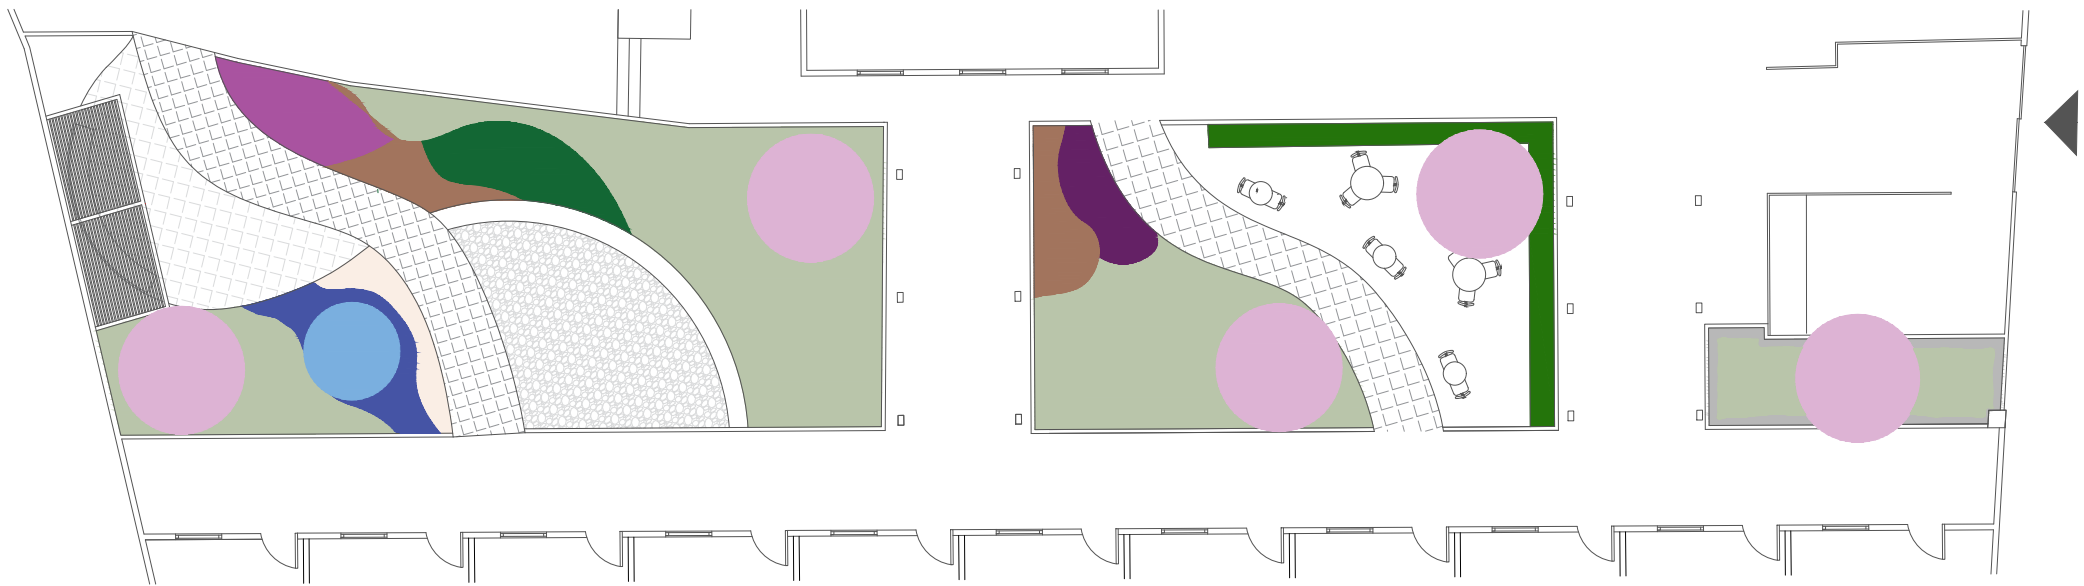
Planta de distribución propuesta.. (Redrován, 2024).
